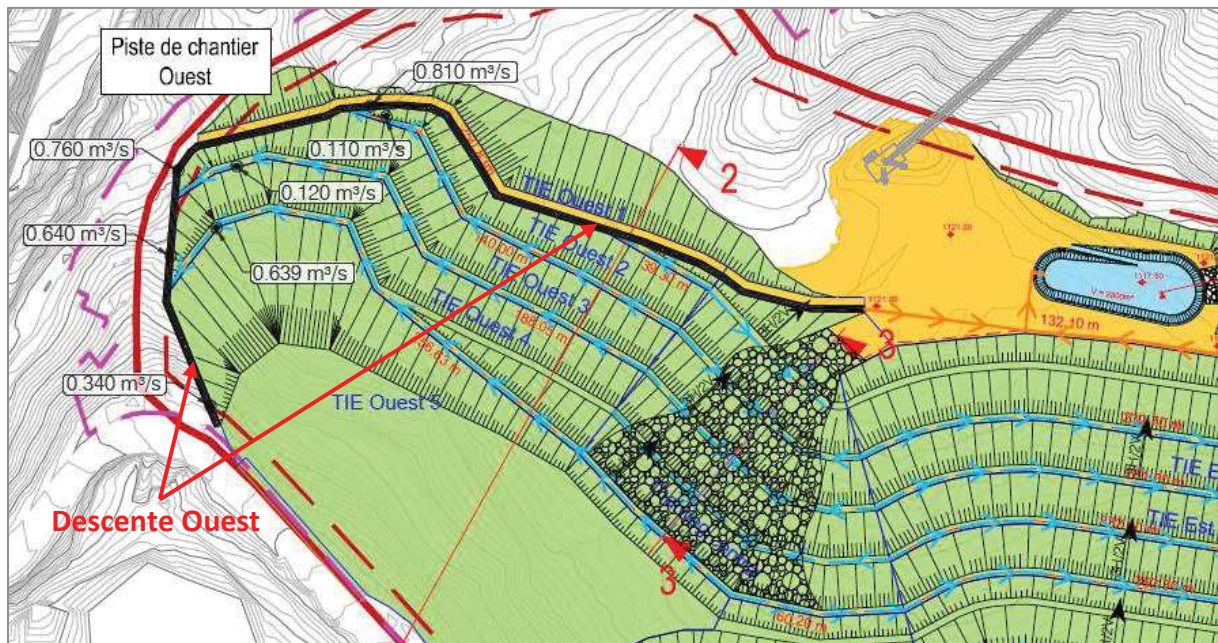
Zoom sur la descente Ouest du site (ALLTI, juin 2021)
